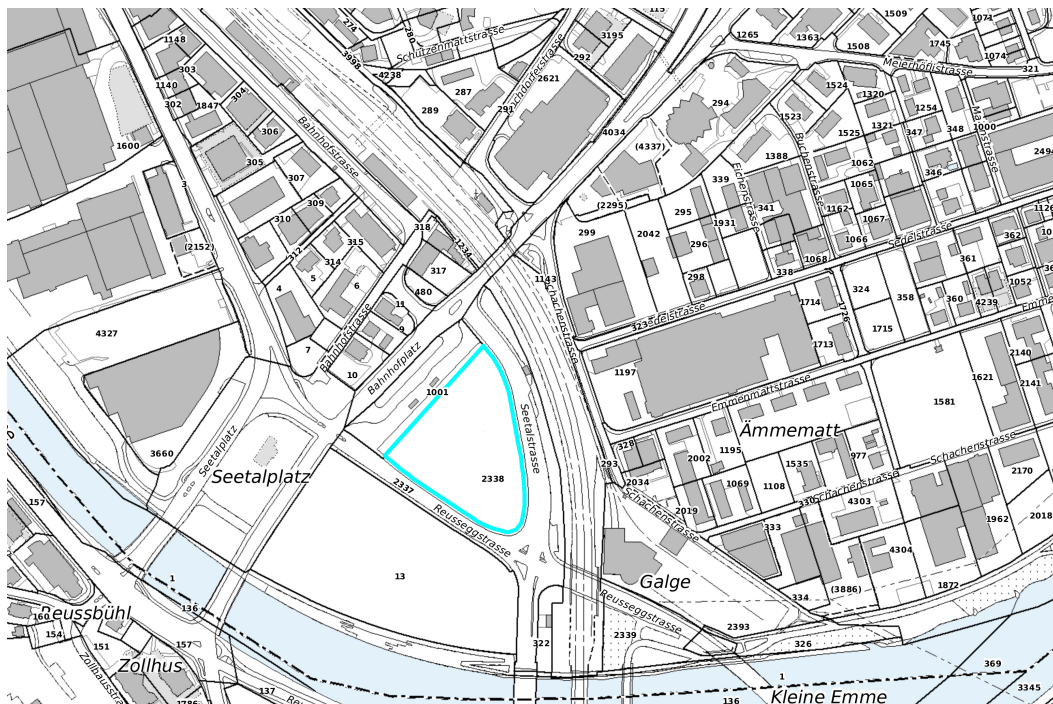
Situationsplan und Planungsperimeter Baufeld A1 (blau markiert)
